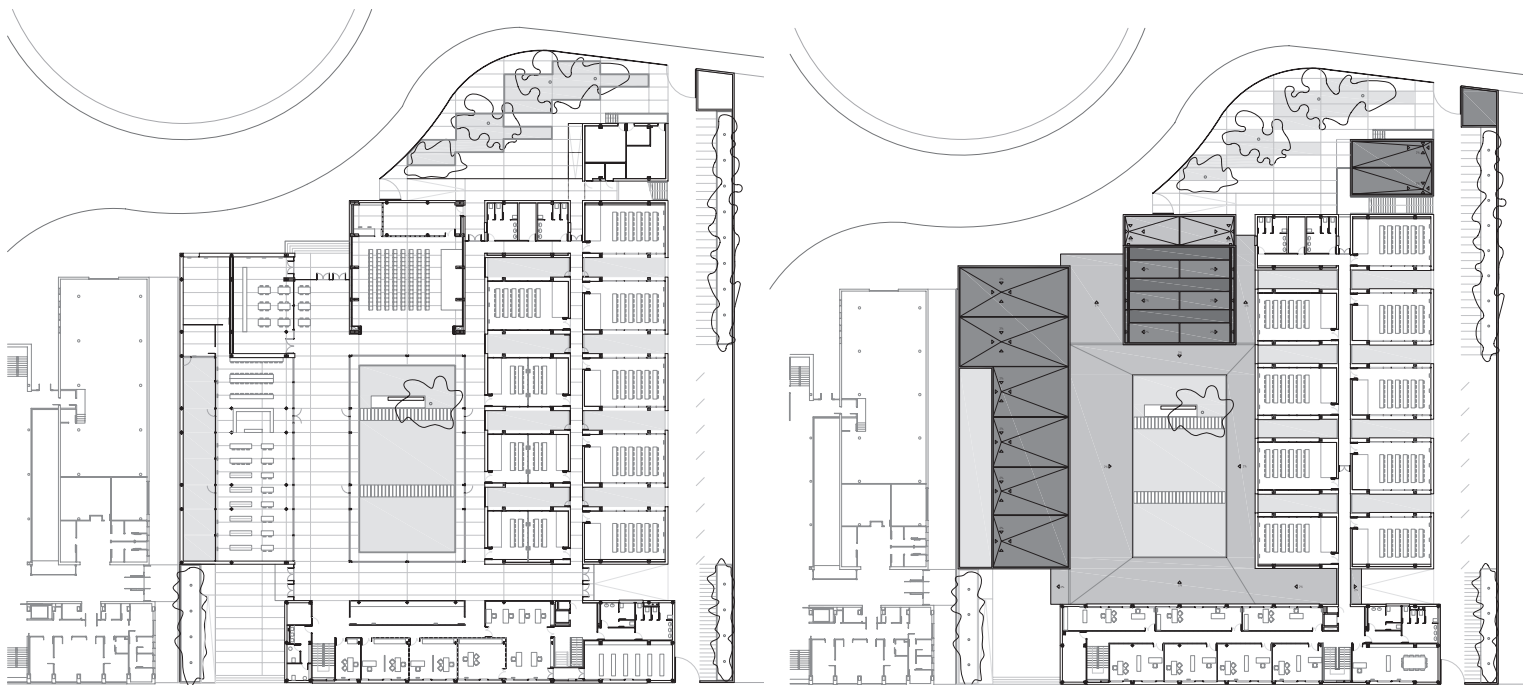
Planta baja (izquierda) y planta primera (derecha) (2008) / Figure 3. Ground floor (left) and first floor (right) (2008).
